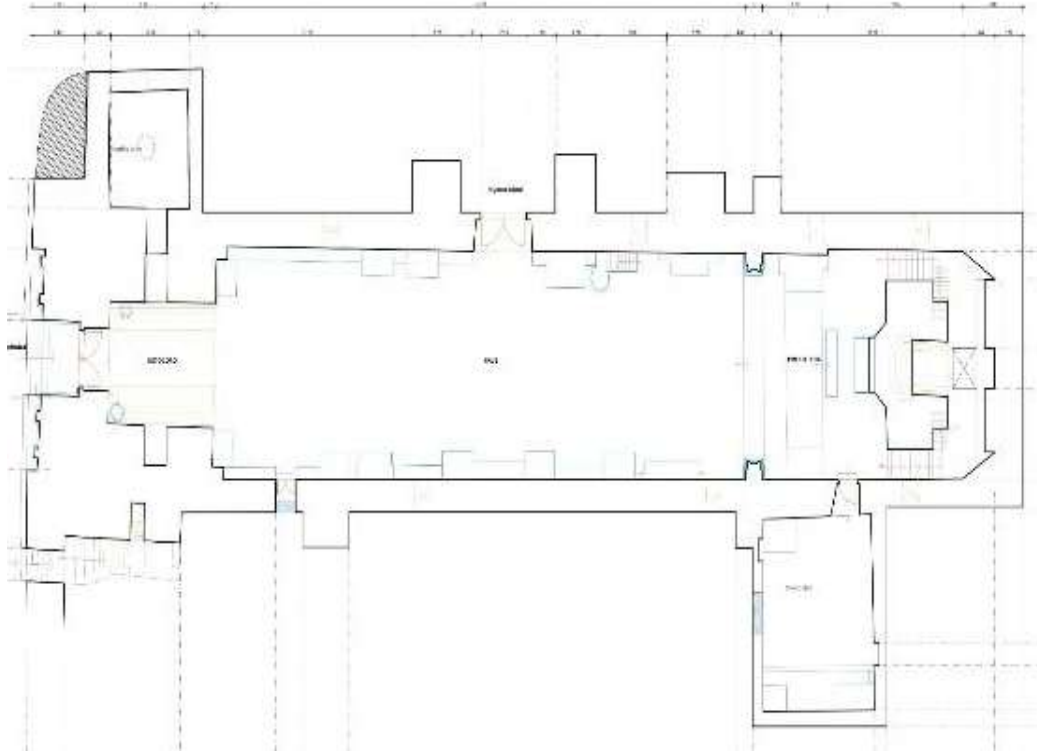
Plano de planta (Santiago Apóstol de Madrigal)
